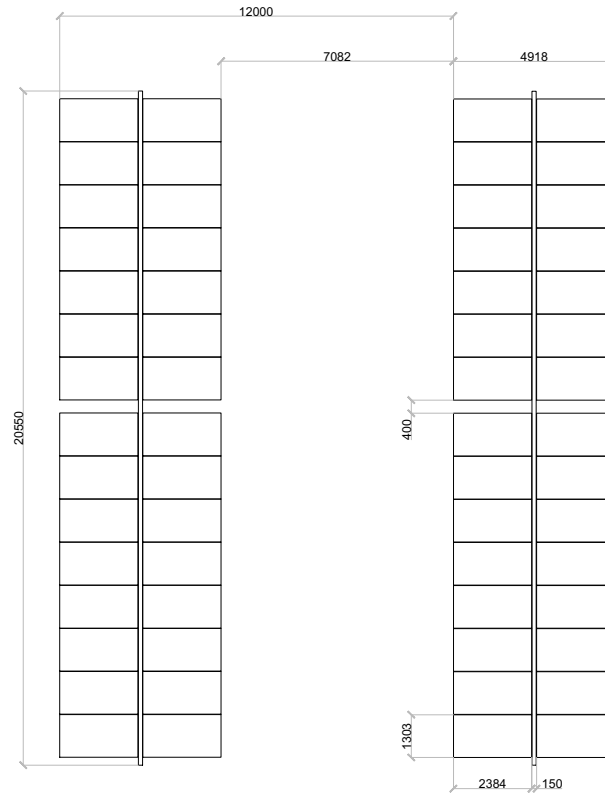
Vista in pianta delle stringhe fotovoltaiche previste a progetto.
